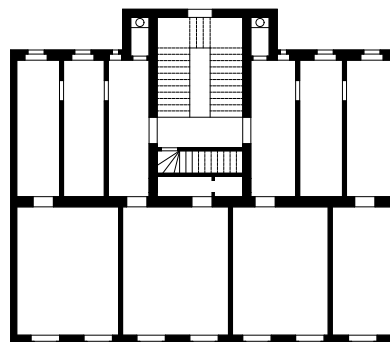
Typischen Gründerzeitgebäude im Grundriss
